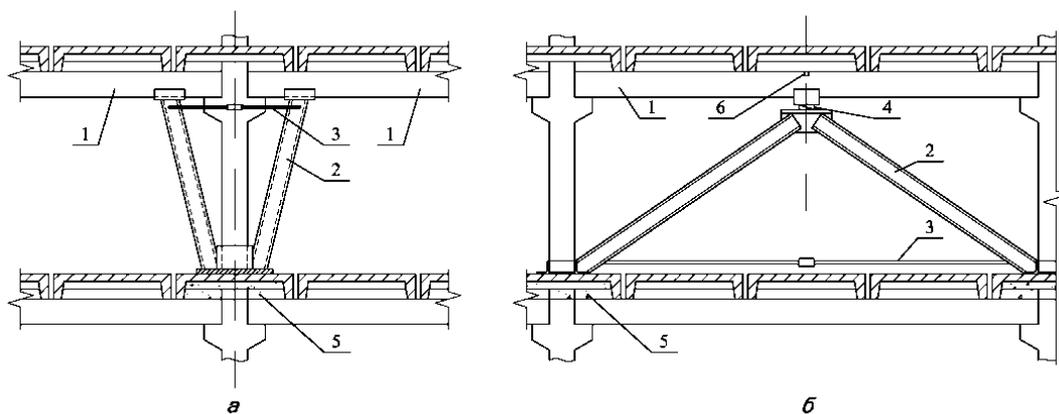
Усиление конструкции дополнительной жёсткой опорой в виде подкосов: а – у опоры; б – в пролёте; 1 – усиливаемая конструкция; 2 – подкос; 3 – затяжка; 4 – клиновидные прокладки; 5 – заполнение бетоном; 6 – надрез по оси опоры
